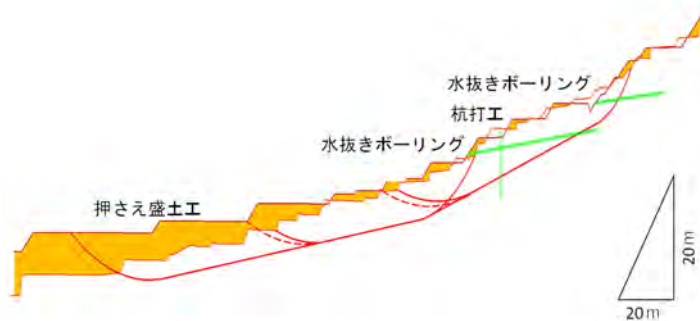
上棚地区（長崎県）の押え盛土工平面図
